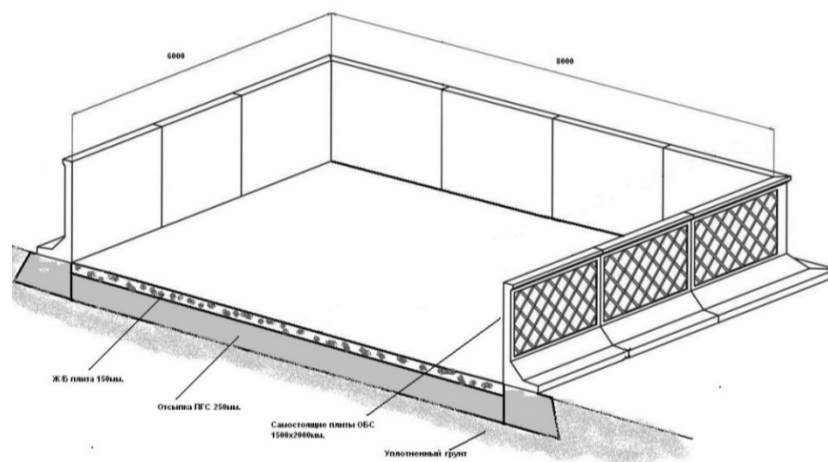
Схема контейнерной площадки КПЛ-3 фирм ООО «Кавалер»
